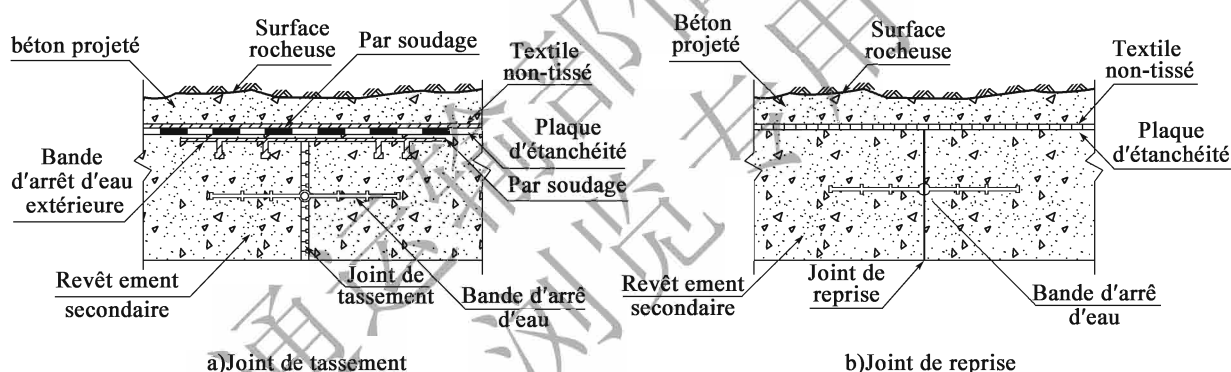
Structure principale du joint de tassement et du joint de reprise du revêtement secondaire
